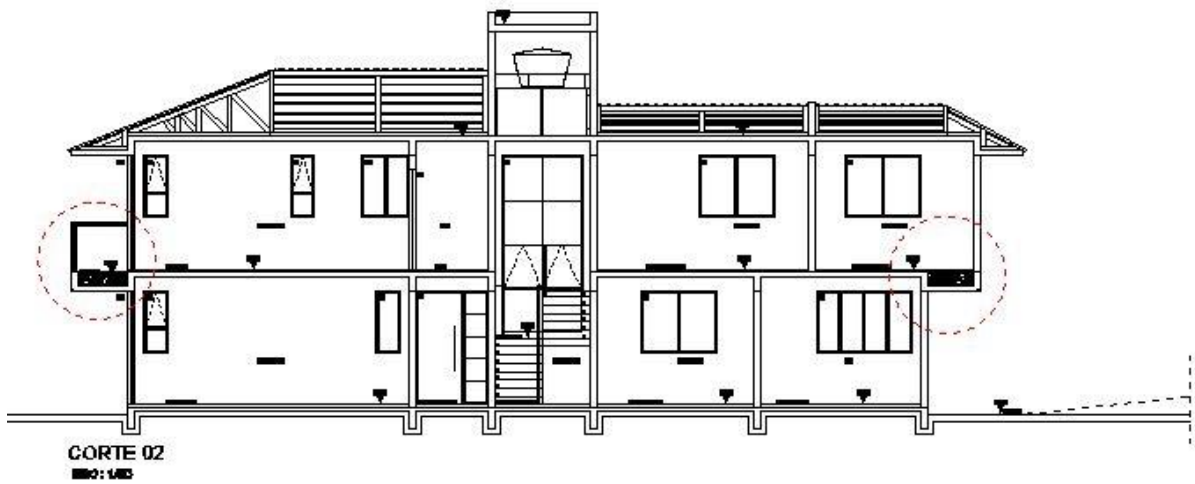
Corte 2 do projeto arquitetônico detalhe na laje
